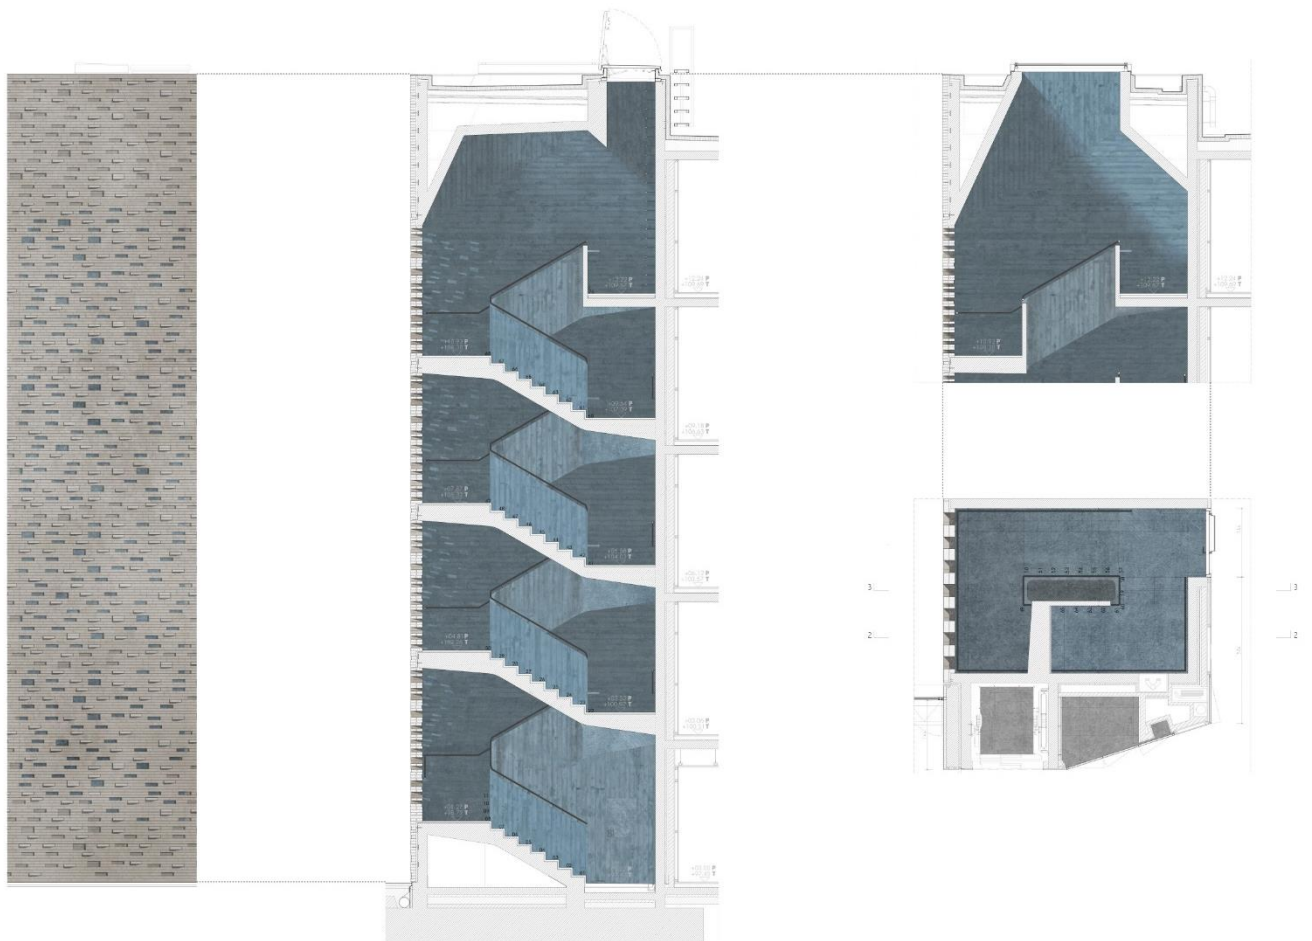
Alçado, cortes e planta do acesso vertical da zona azul.
